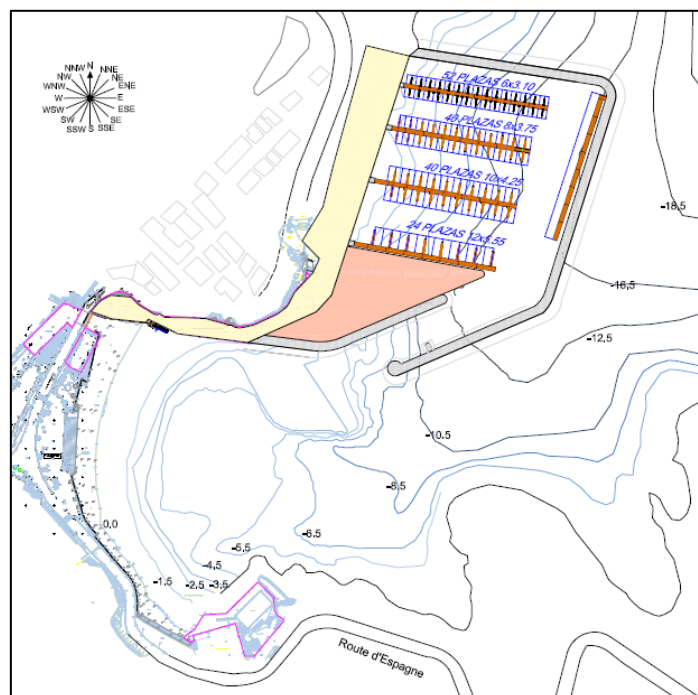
Vista en planta de la alternativa escogida mediante el análisis multicriterio.
